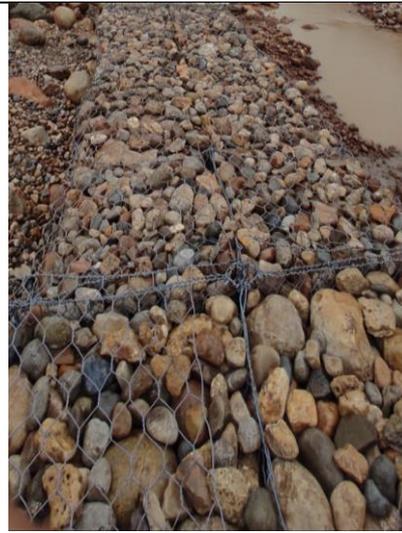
Deficiente distribución de las piedras colocadas en el muro con gavión
